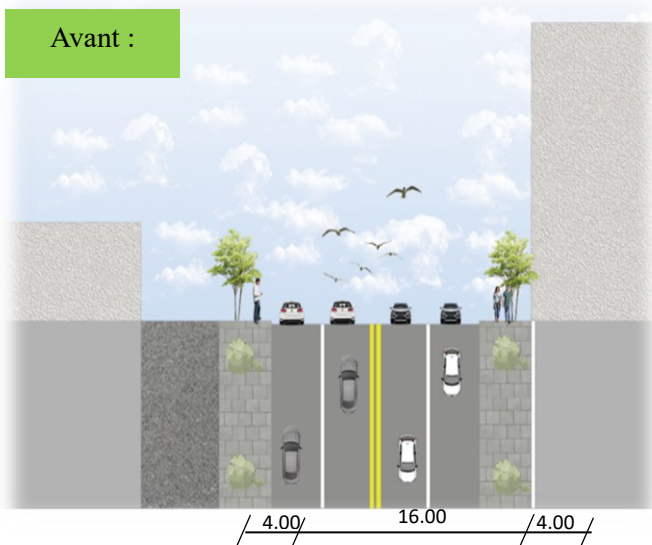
plan et coupe de l'avenue Chabane Ahcene de deuxième séquence avant l'intervention.
